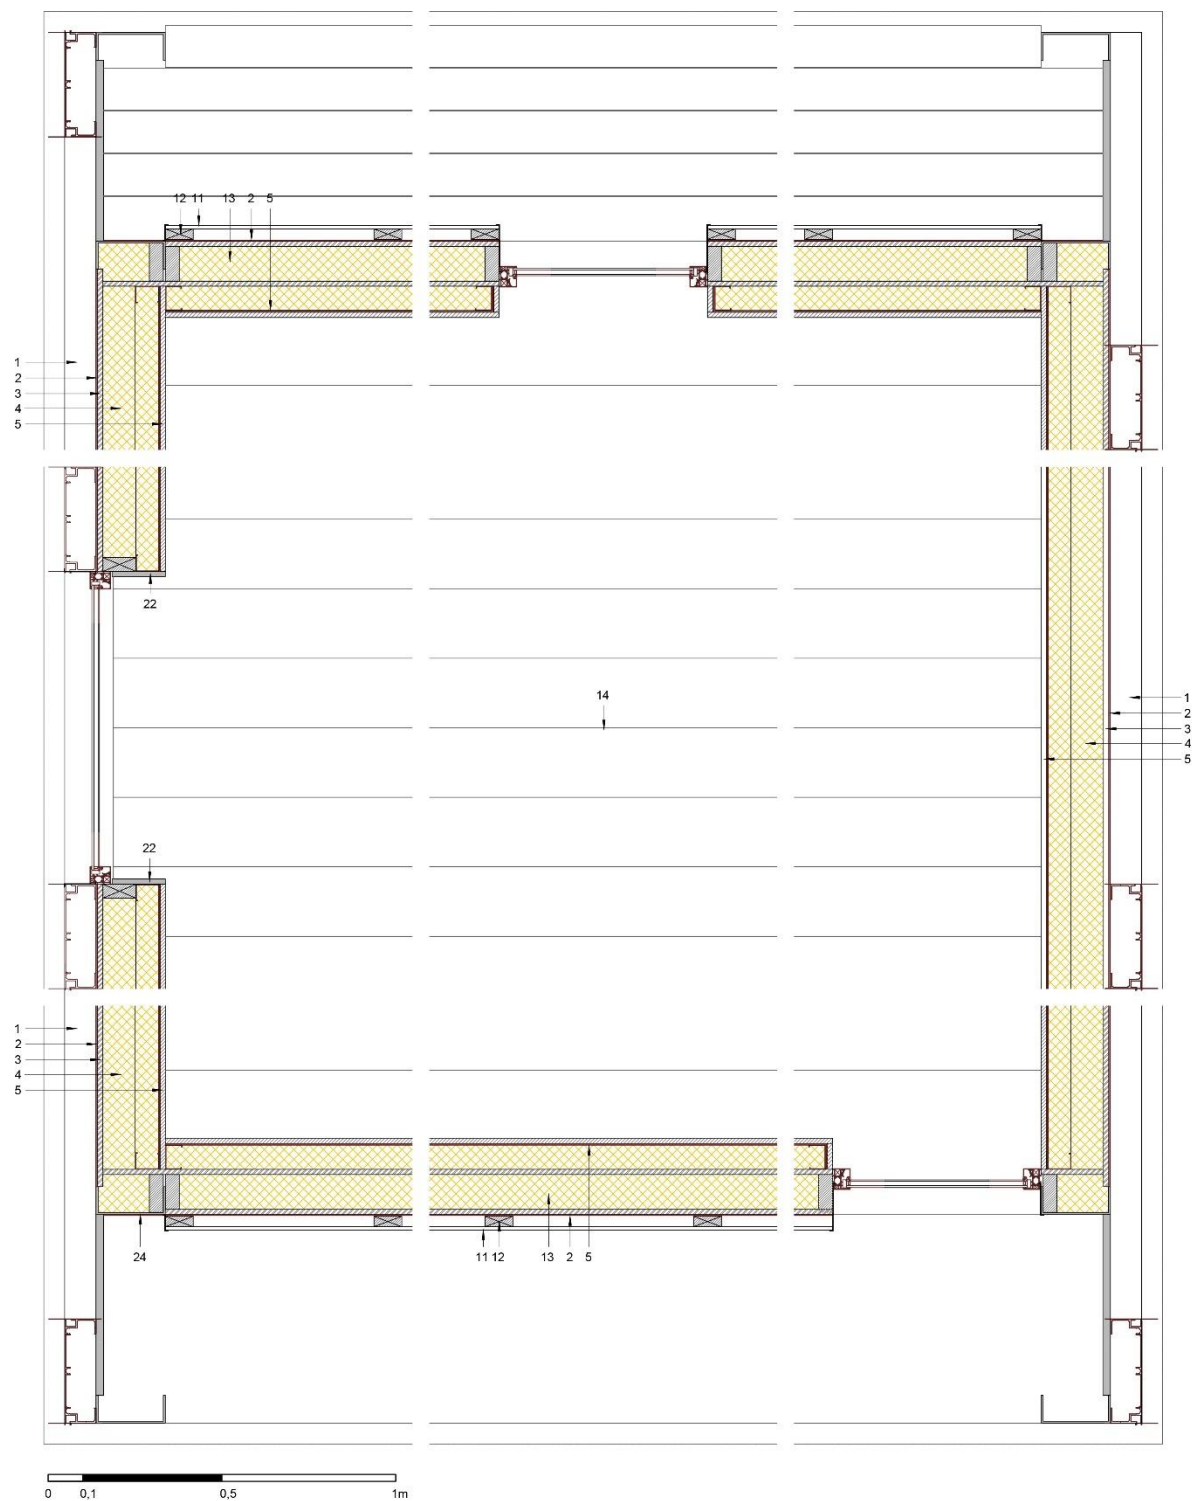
Detalles constructivos en planta. Fuente: Víctor Hermo Sánchez.
